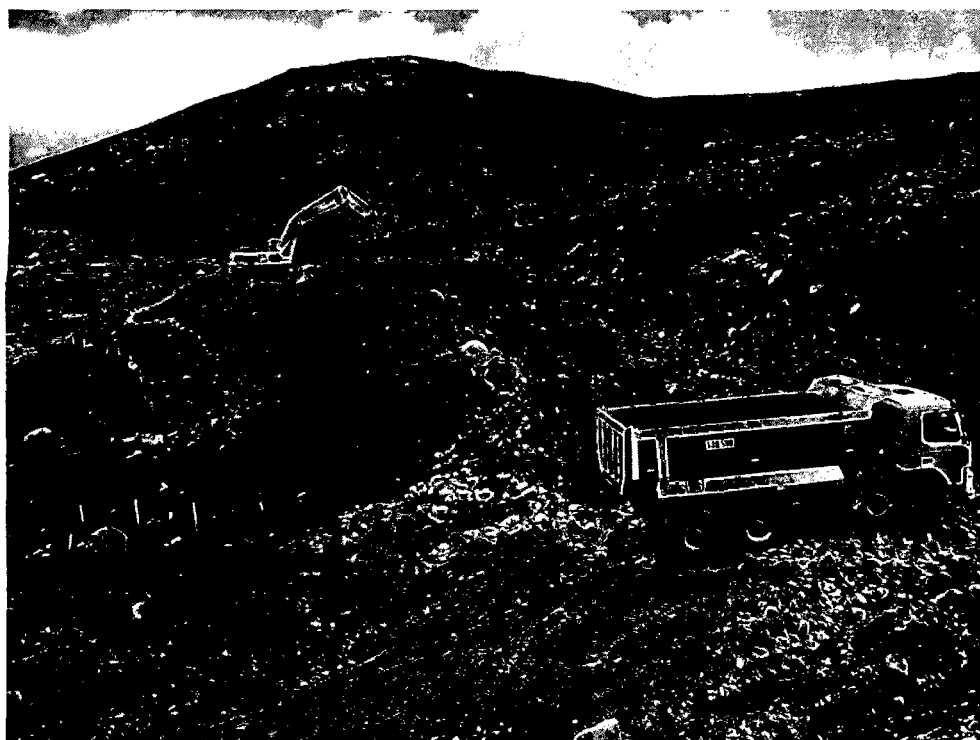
Corte y perfilado de taludes con excavadora para eliminación de material.
